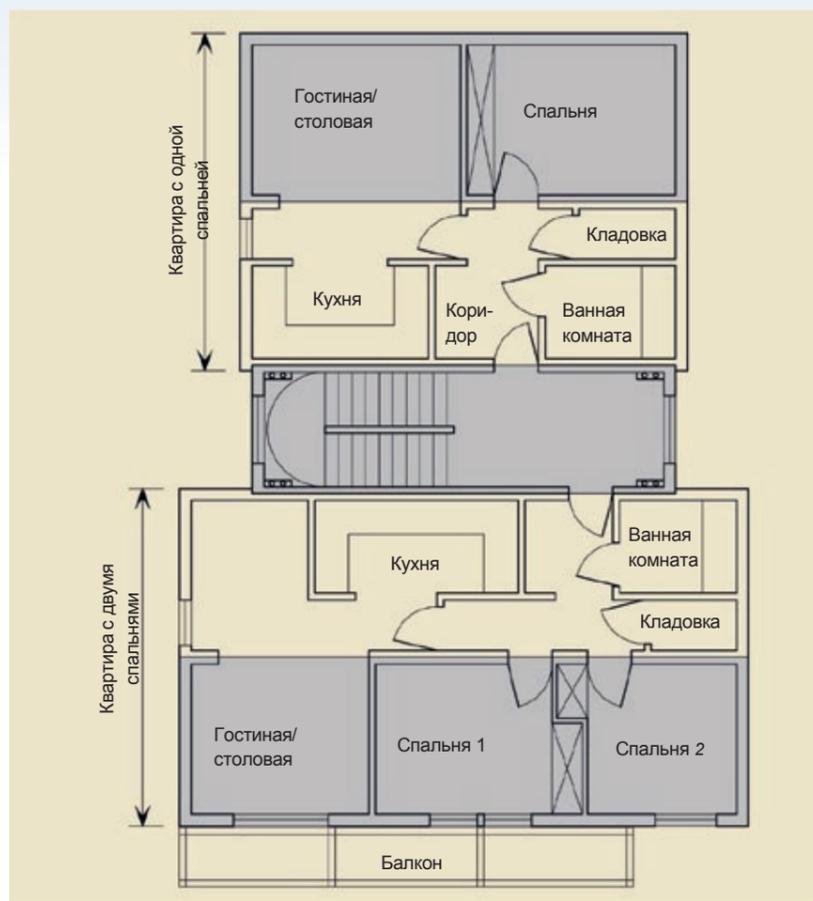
План этажа модульного жилого здания (отдельные блоки здания выделены цветом)
